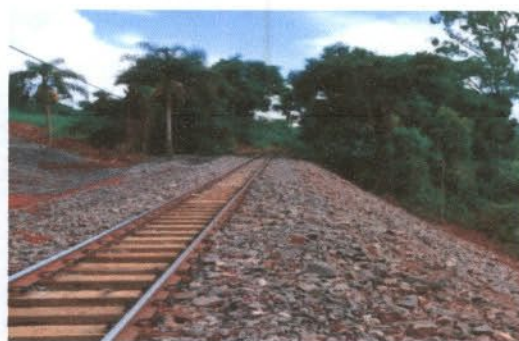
Finalização dos trabalhos de infra e superestrutura.
